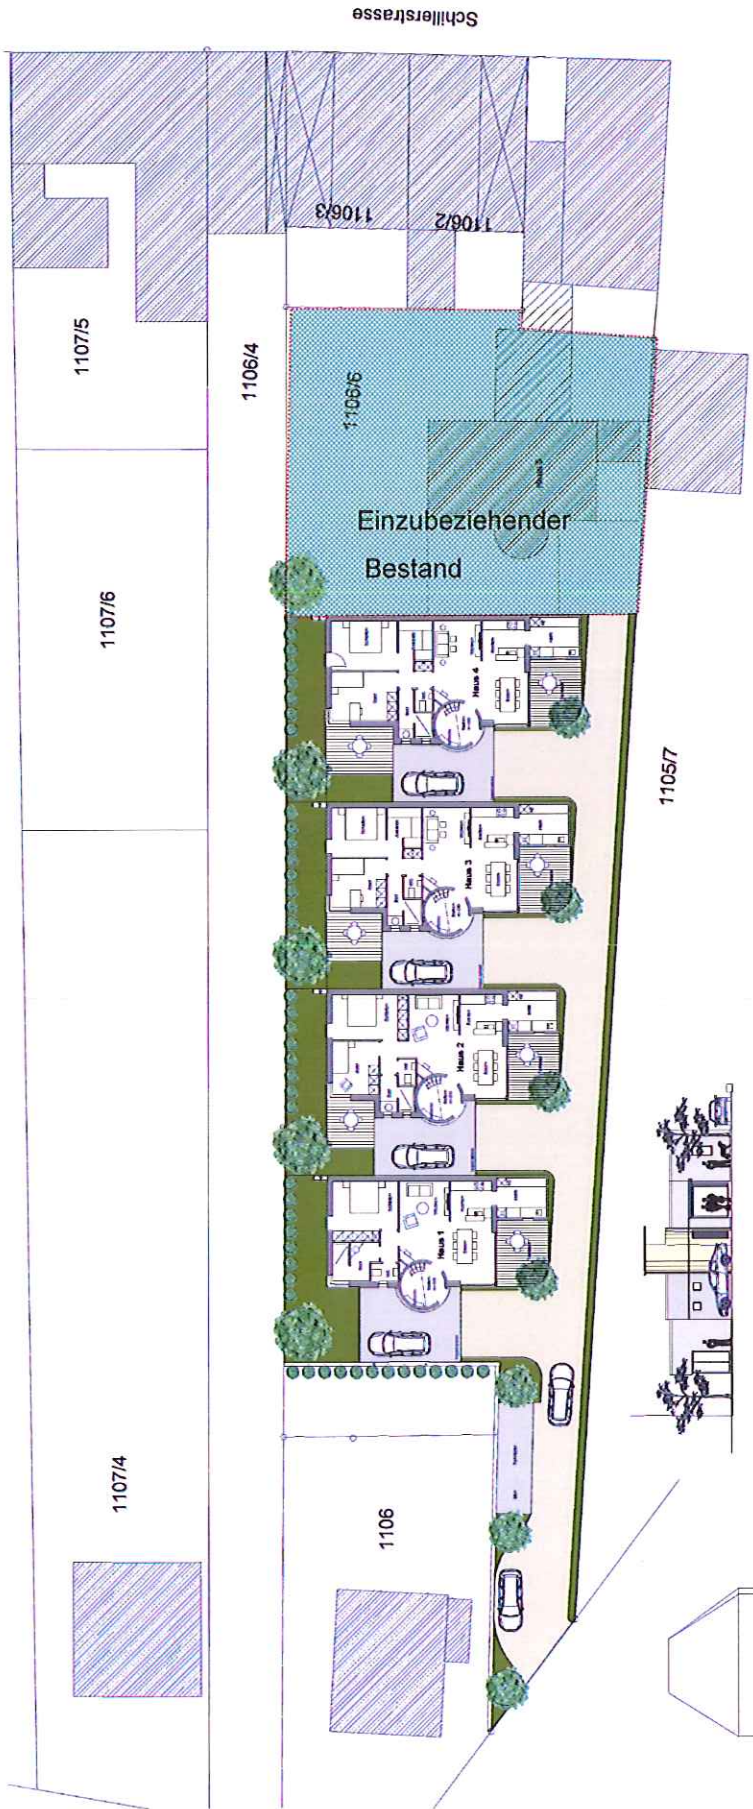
Lageplan des vorgesehenen Bauvorhabens mit 4 weiteren Objekten /3/
